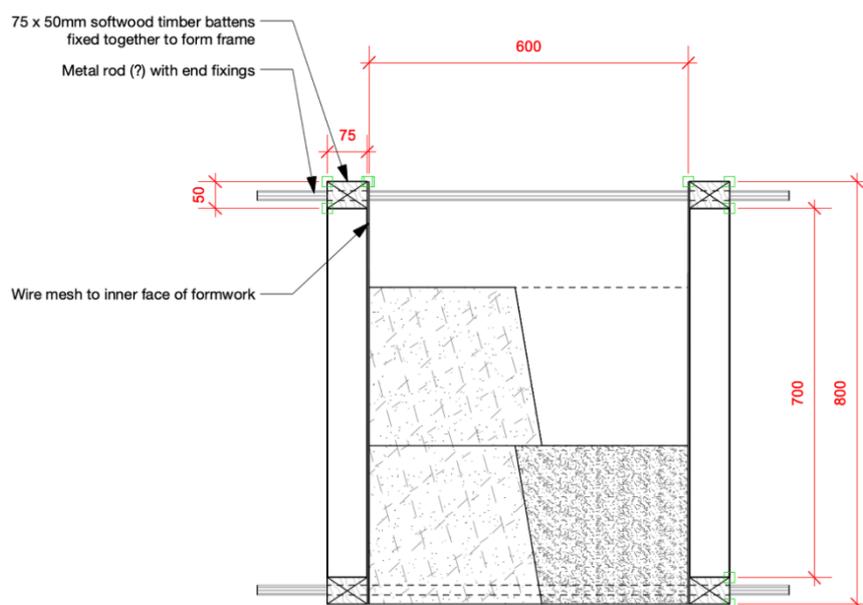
Dessin en coupe transversale de coffrage et de matériau CobBauge.
